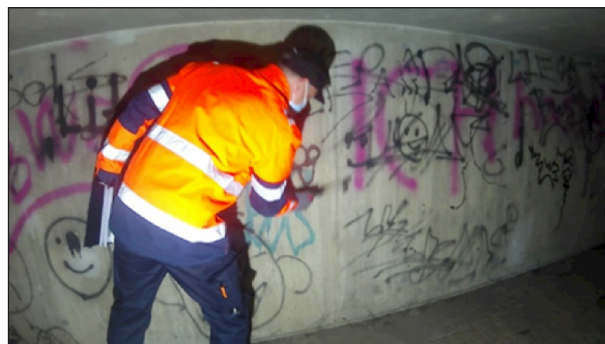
Exemplarische Prüfung der Betonfläche durch Abklopfen
